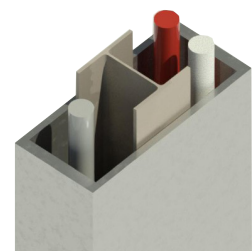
Estrutura + Redes de abastecimento: Axonometria de secção metálica com pilar construtivo e tubagens, concentradas numa só coluna.
